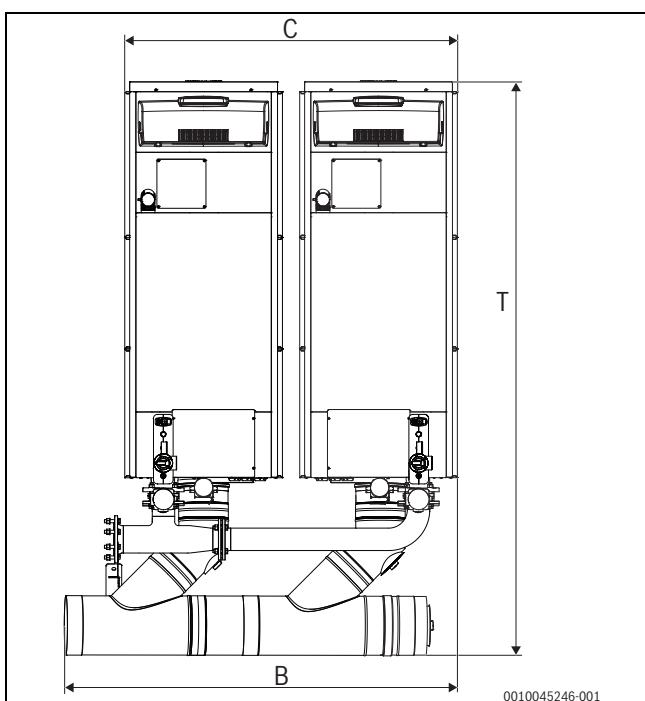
2-Kessel-Kaskade hinter dem Kessel (Draufsicht)
